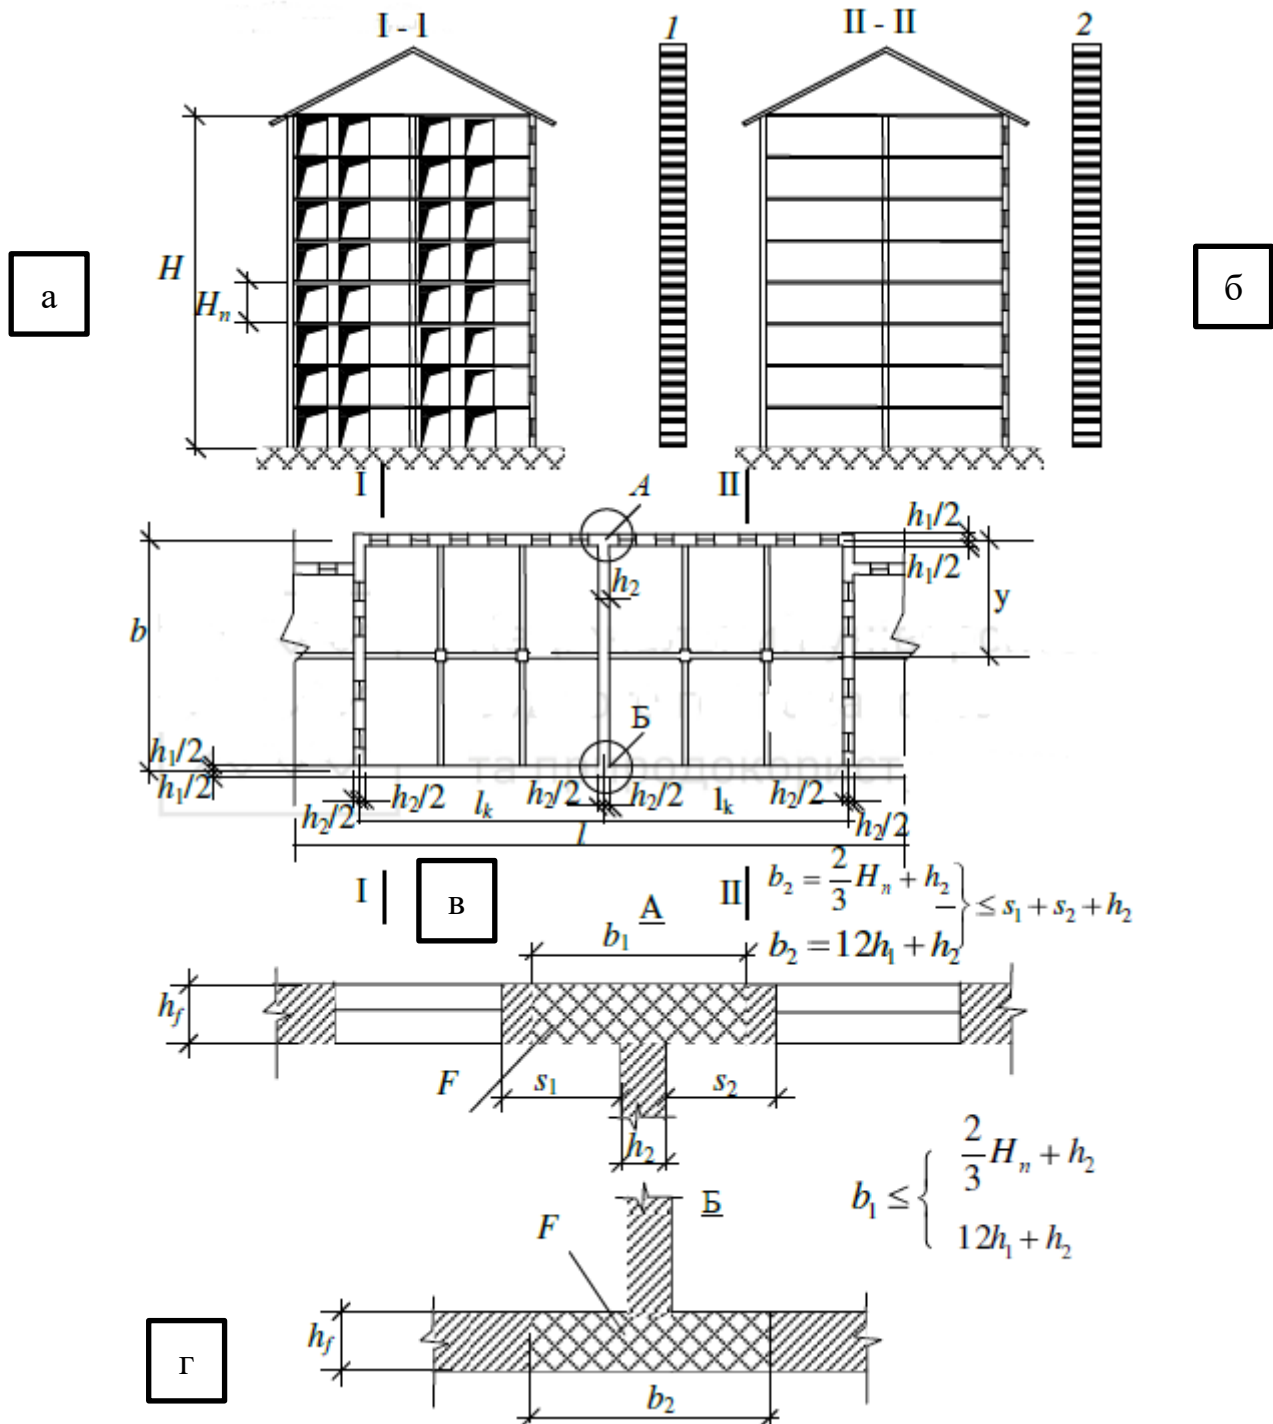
Схеми до розрахунку будівель із жорсткою конструктивною системою (рис. 4.3, [7]: а, б – розрахункові схеми будівель у вигляді складених консолей (перерізи I-I, II-II); в – плани поперечних перерізів консолей; г – вигляд поперечних перерізів консолей в перерізі I-I; 1 – активний тиск вітру; 2 – пасивний тиск вітру
